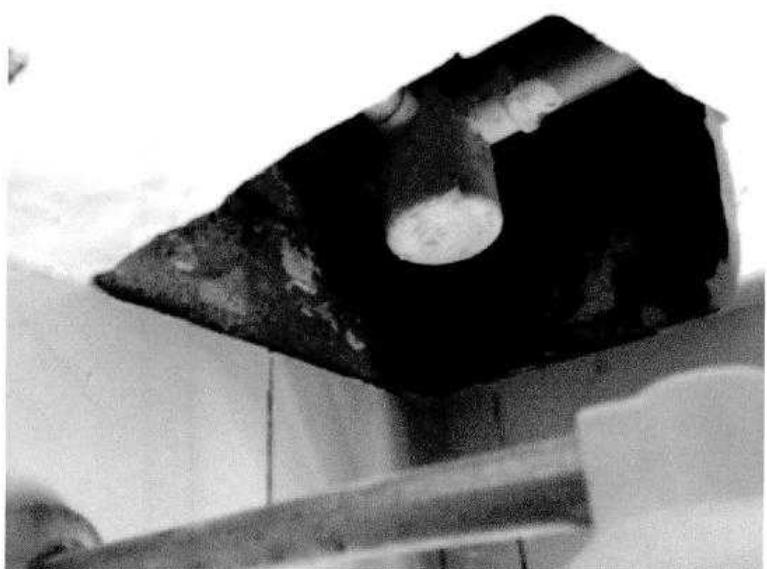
Infiltração oriunda de ralo do Banheiro do apartamento superior (devidamente sanado)
